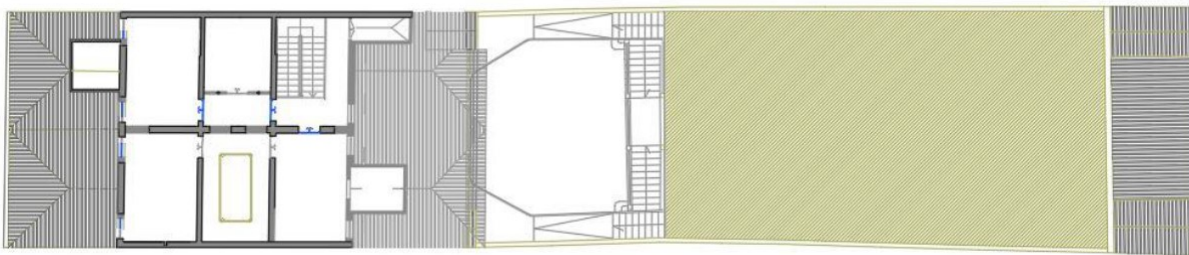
Planta de arquitetura original do piso 3 (sem escala)
